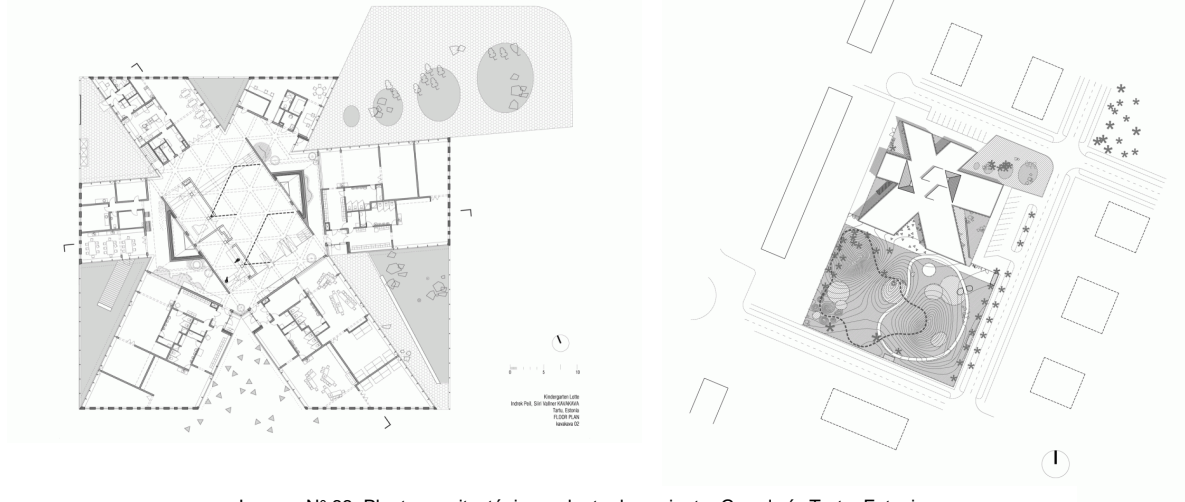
Planta arquitectónica y planta de conjunto, Guardería Tartu, Estonia
